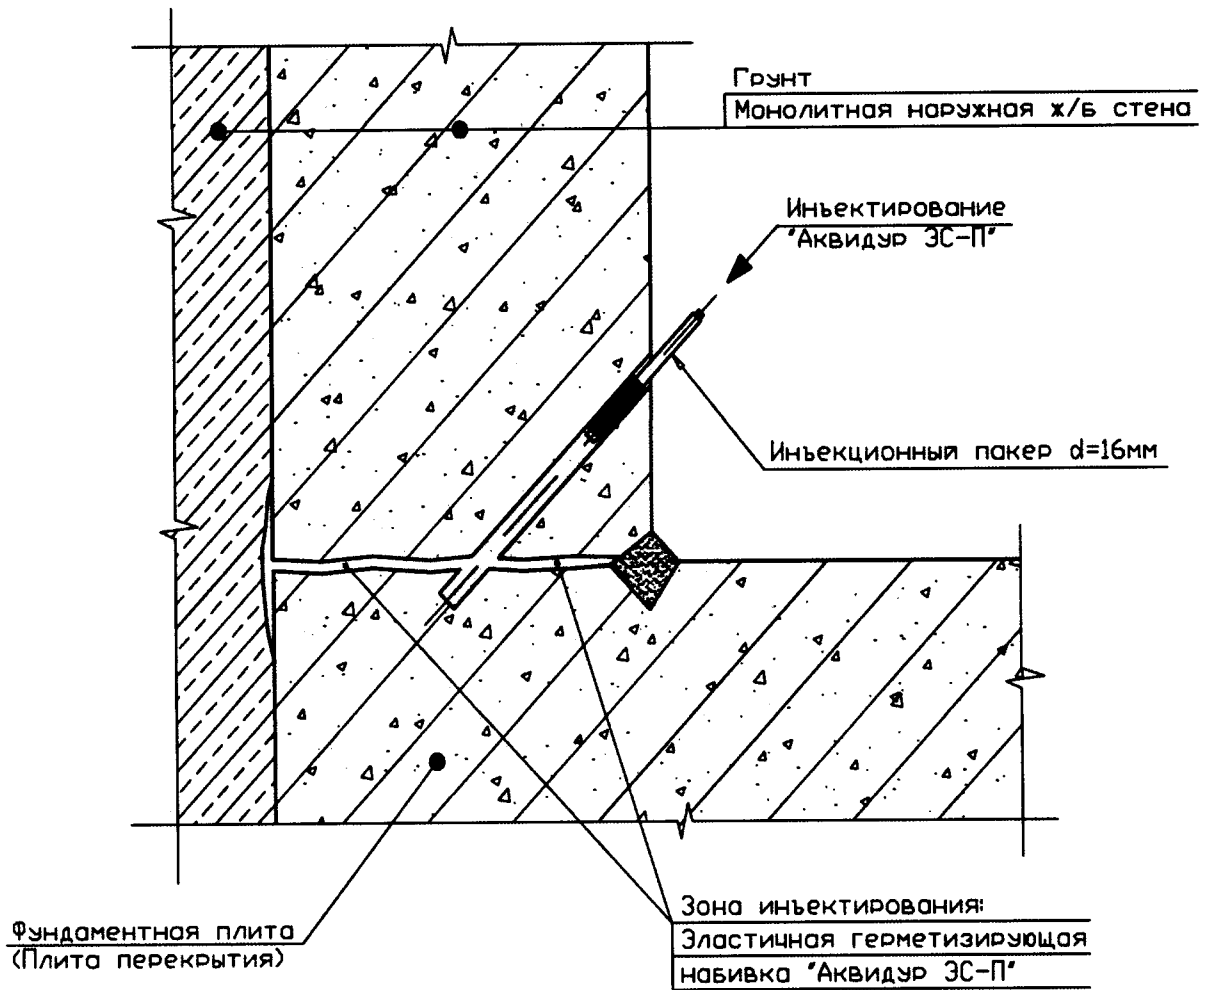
Герметизация конструктивных швов примыкания: «фундаментная плита-наружная стена», «плита перекрытия-наружная стена». Инъектирование шва
